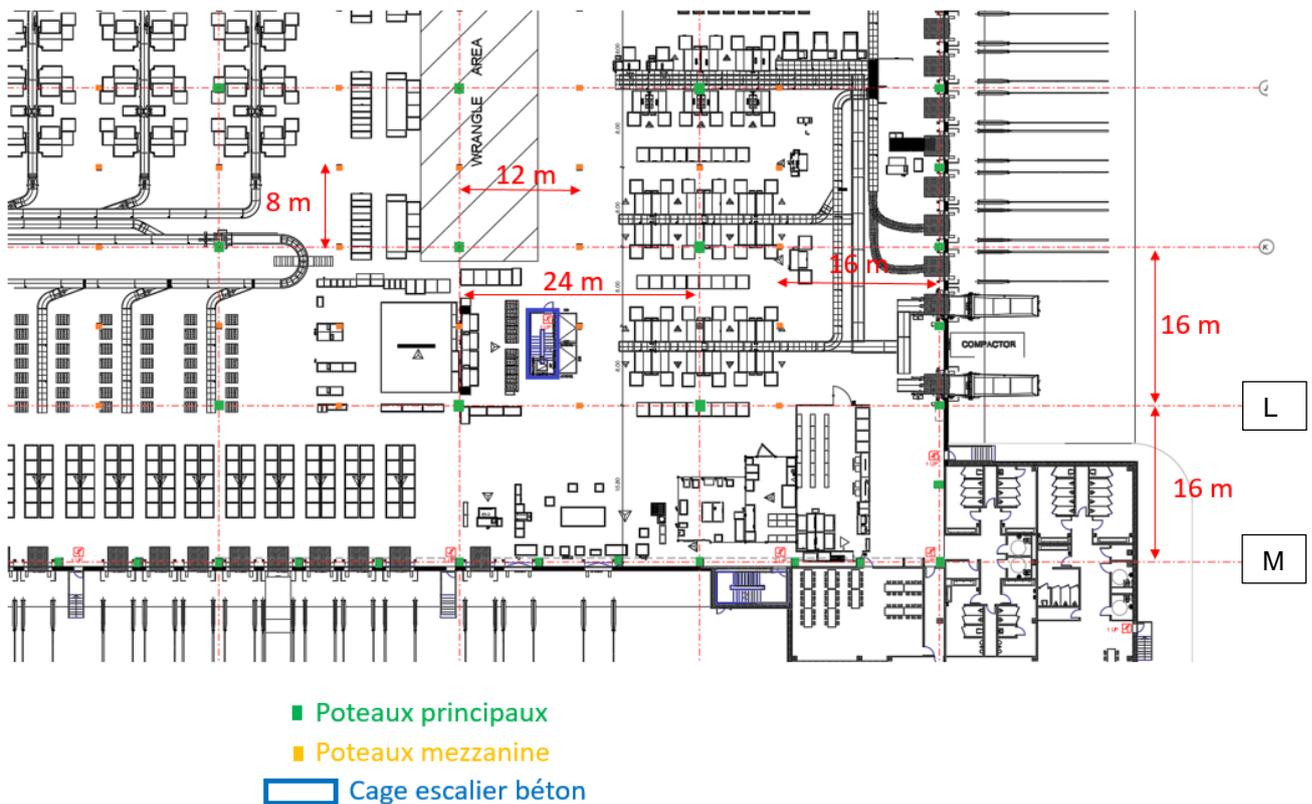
Position des poteaux dans la zone mezzanine.
